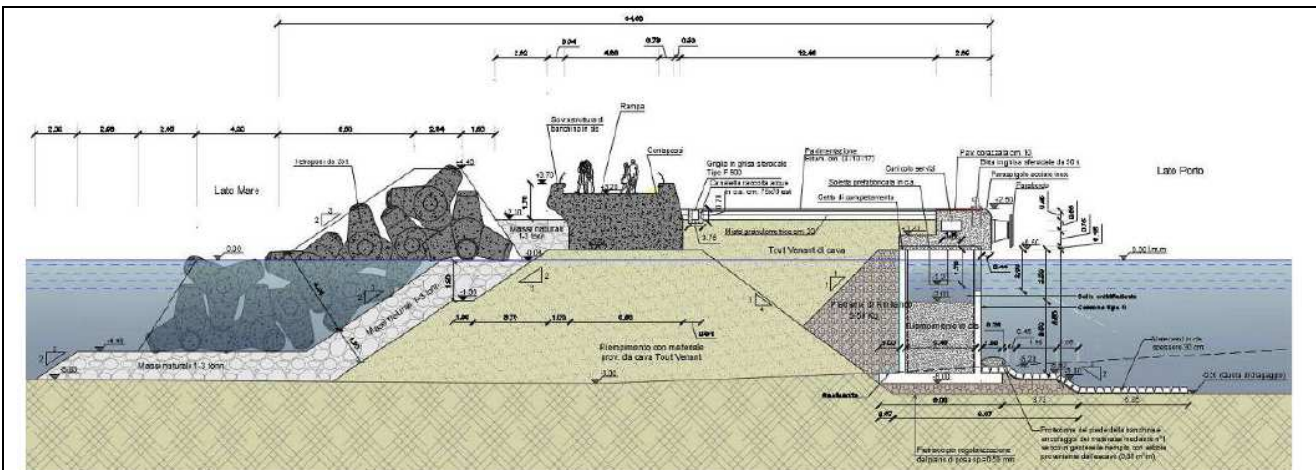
Sezione tipo H-H: Tratto a gettata con tetrapodi
